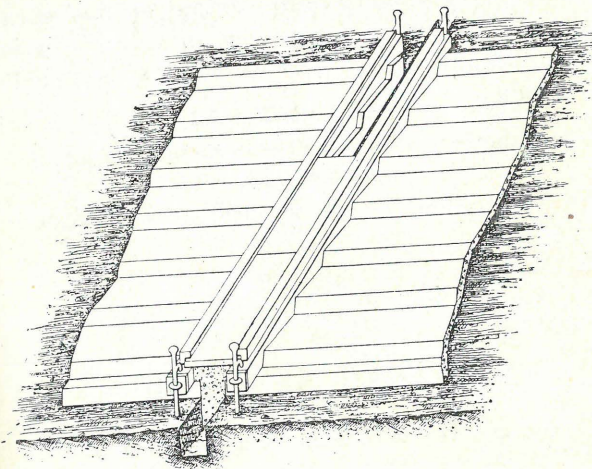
Exécution de la poutre de l'encastrement en béton.
